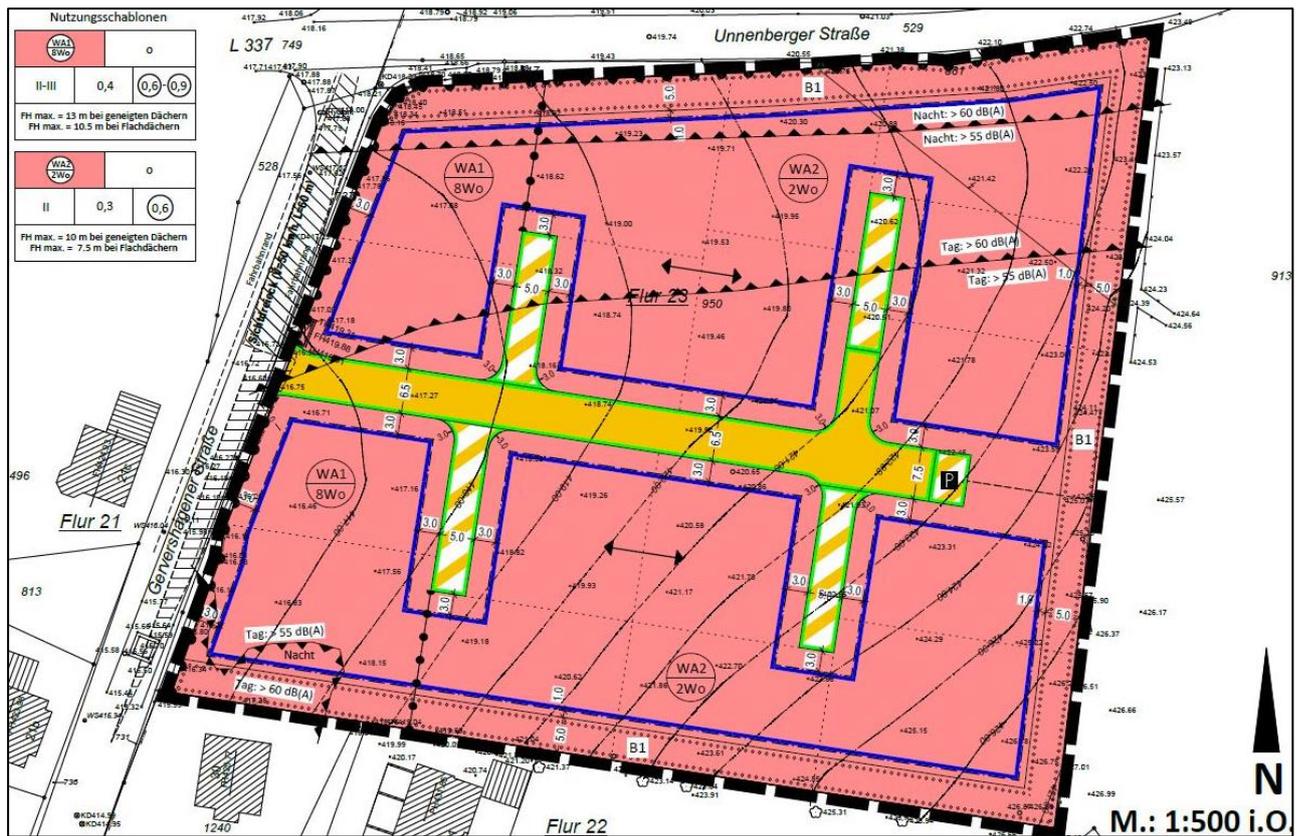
Planzeichnung Bebauungsplan, Quelle: HKS, 2020
